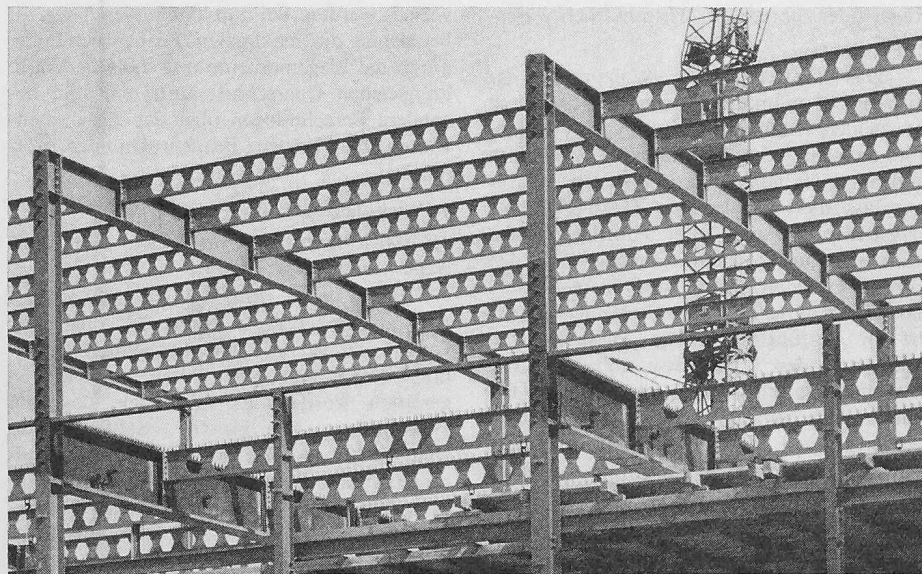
Wabenträger als Verbund-Deckenträger. Ausführung der Decken mit Betonfertigplatten und Ortsbeton. Brauerei Haldengut, neues Flaschengeschäft, Winterthur
